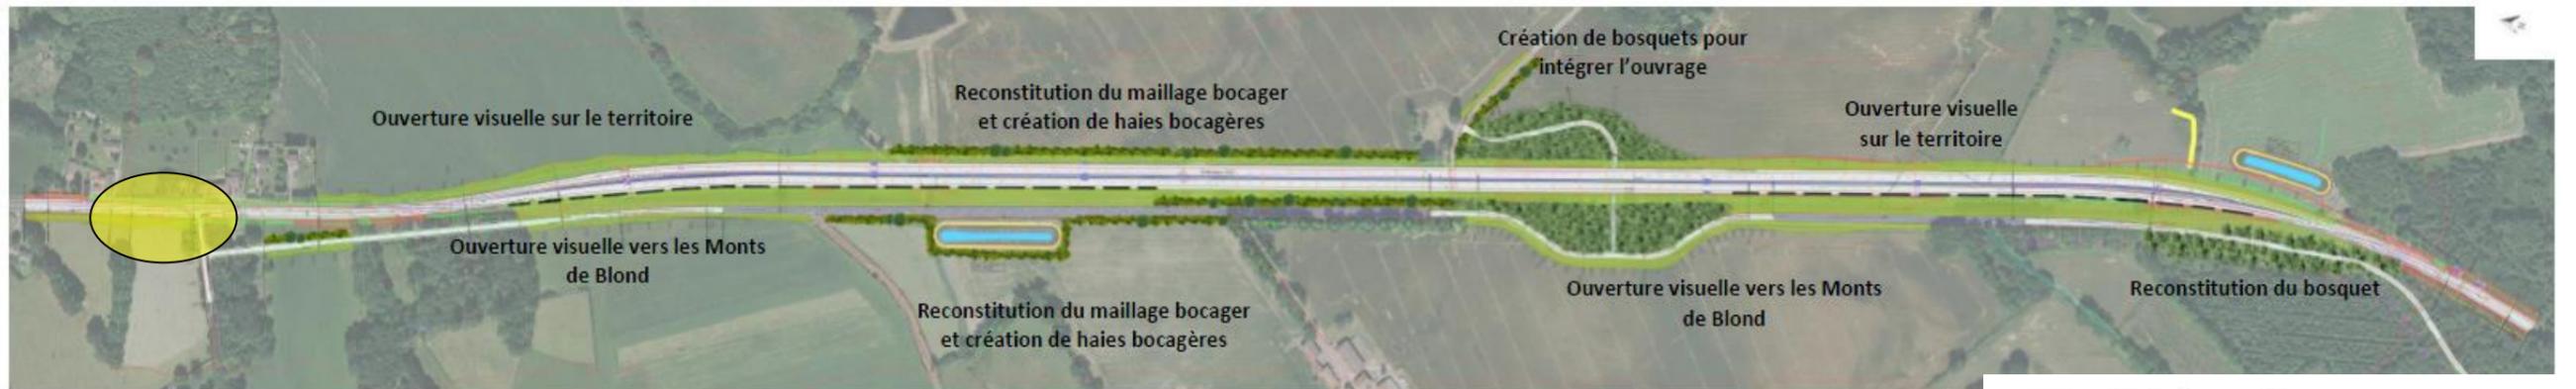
Vue en plan des aménagements paysagers sur la section de Chamboret
